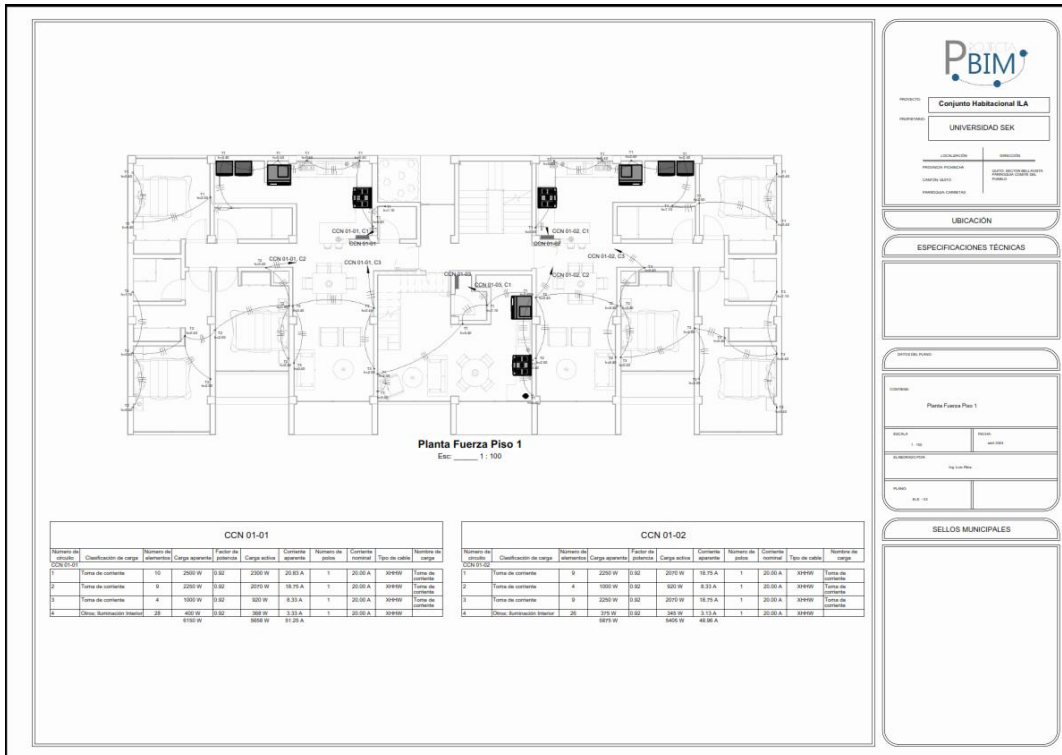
Plano Eléctrico Fuerza Piso 1 B1
